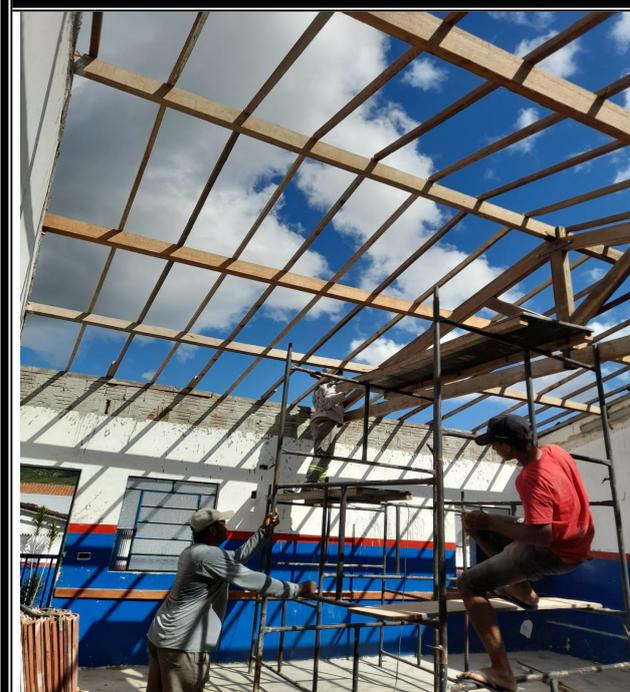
INSTALAÇÃO DE LINHAS E CAIBROS.
